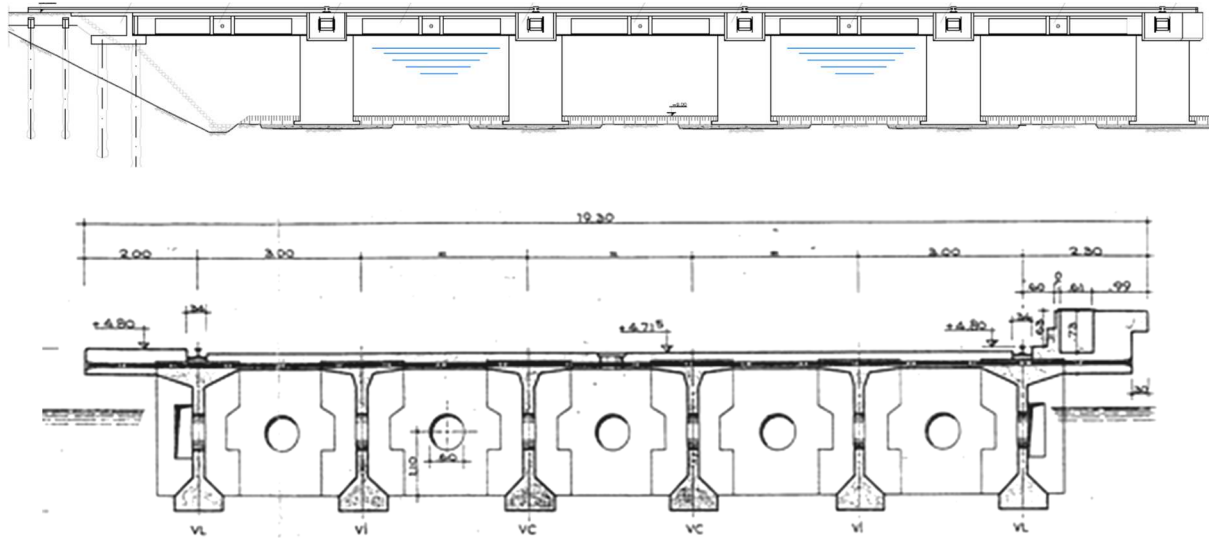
Estrutura das pontes cais. Alçado e corte transversal
